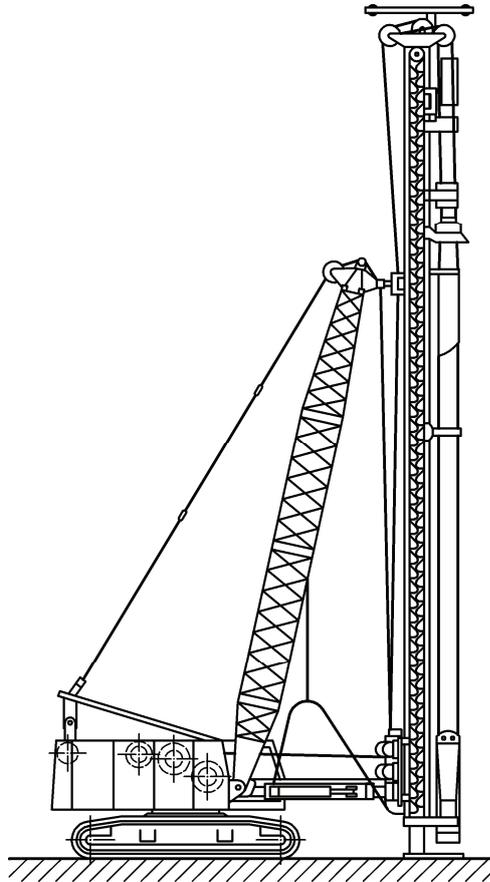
Seilbagger auf Kettenlaufwerk mit Bohrausrüstung (Verrohrungsmaschine)
